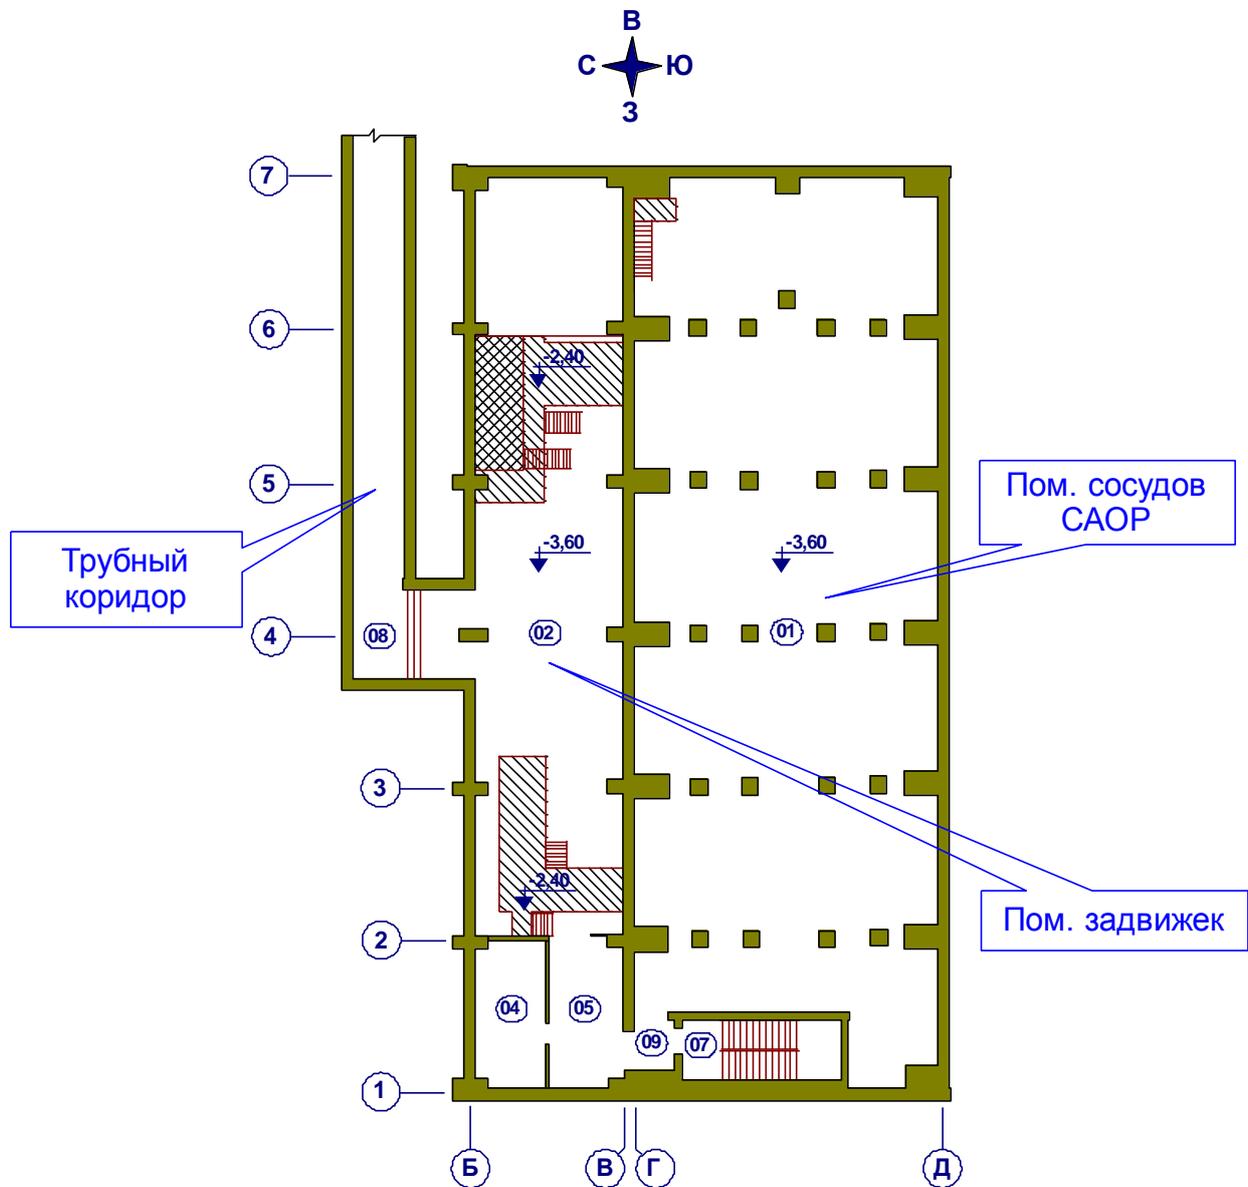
План здания 117/1 на отметке -3,60 м
